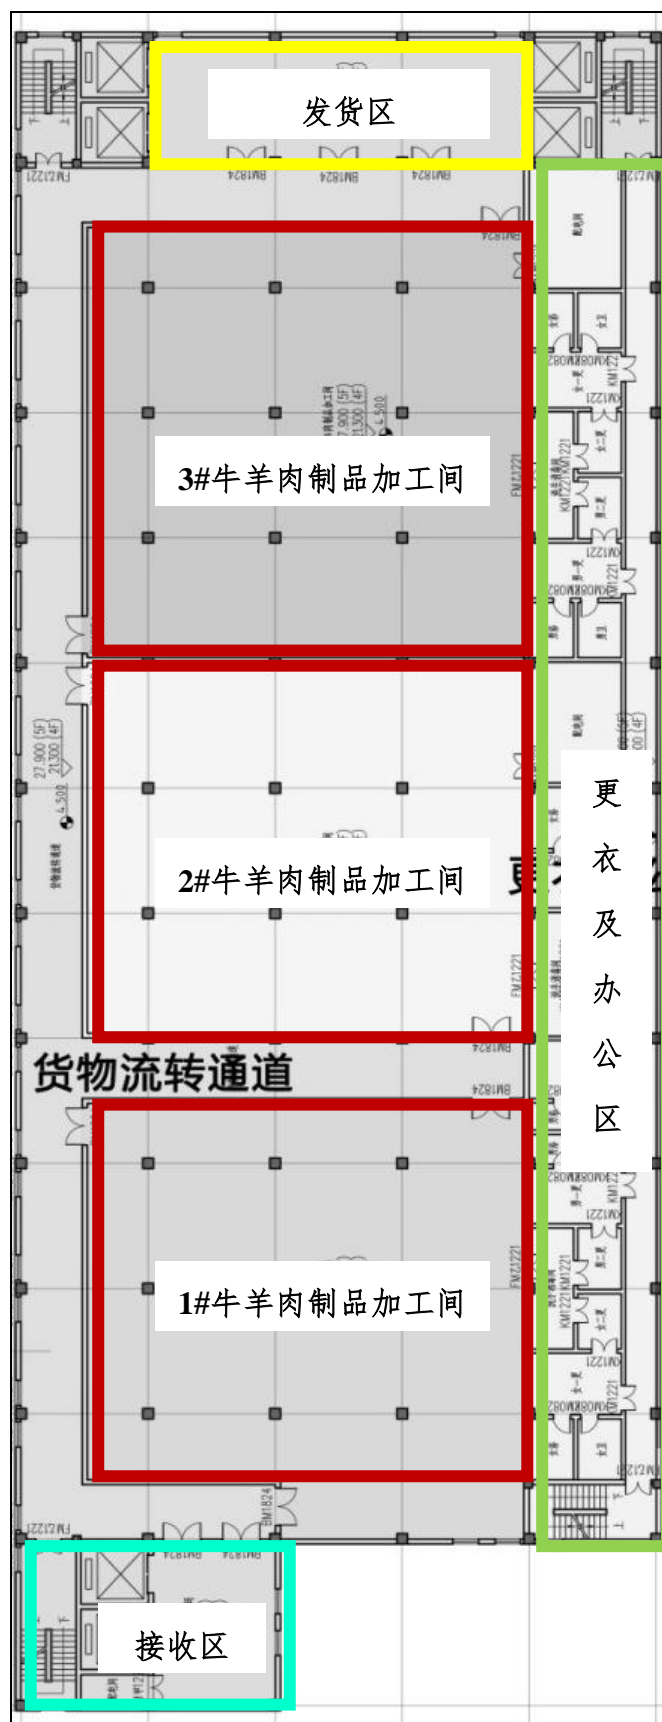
牛羊综合加工车间 4F 及 5F 平面图
